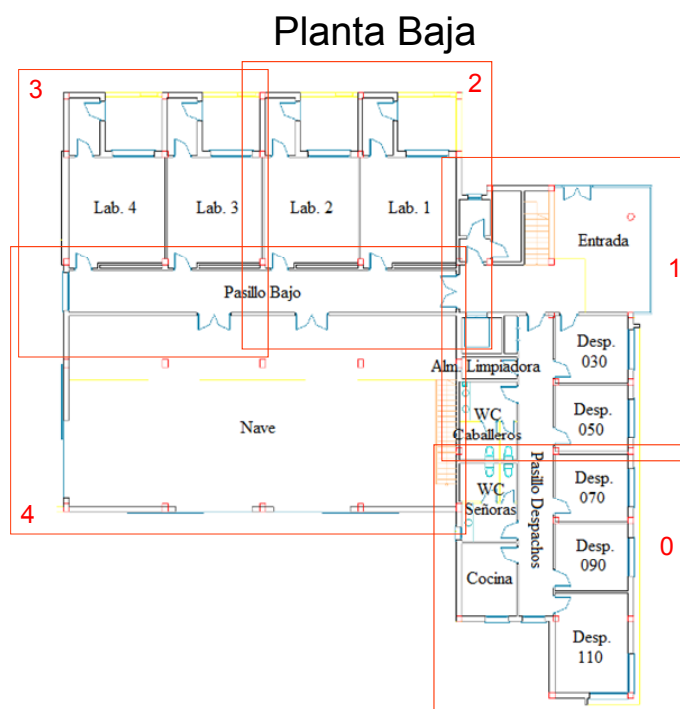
Distribución de los Compact Fieldpoint en la planta baja.
